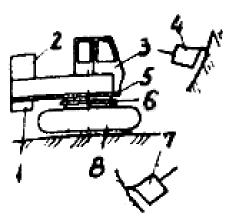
Базовая часть одноковшового экскаватора и основные виды сменного рабочего оборудования 1 - противовес; 2 - силовая установка; 3 - кабина; 4, 7 - труба выхлопных газов; 5 - поворотная платформа; 6 - опорно-поворотное устройство; 8 - ходовое устройство
